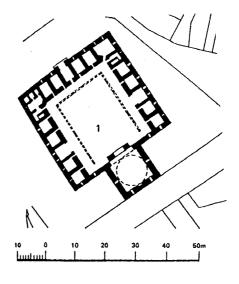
مسقط أفقي لمجمع (كلية) خواندخاتون في قيصرية ٦٣٥هـ/١٣٣٧م.
